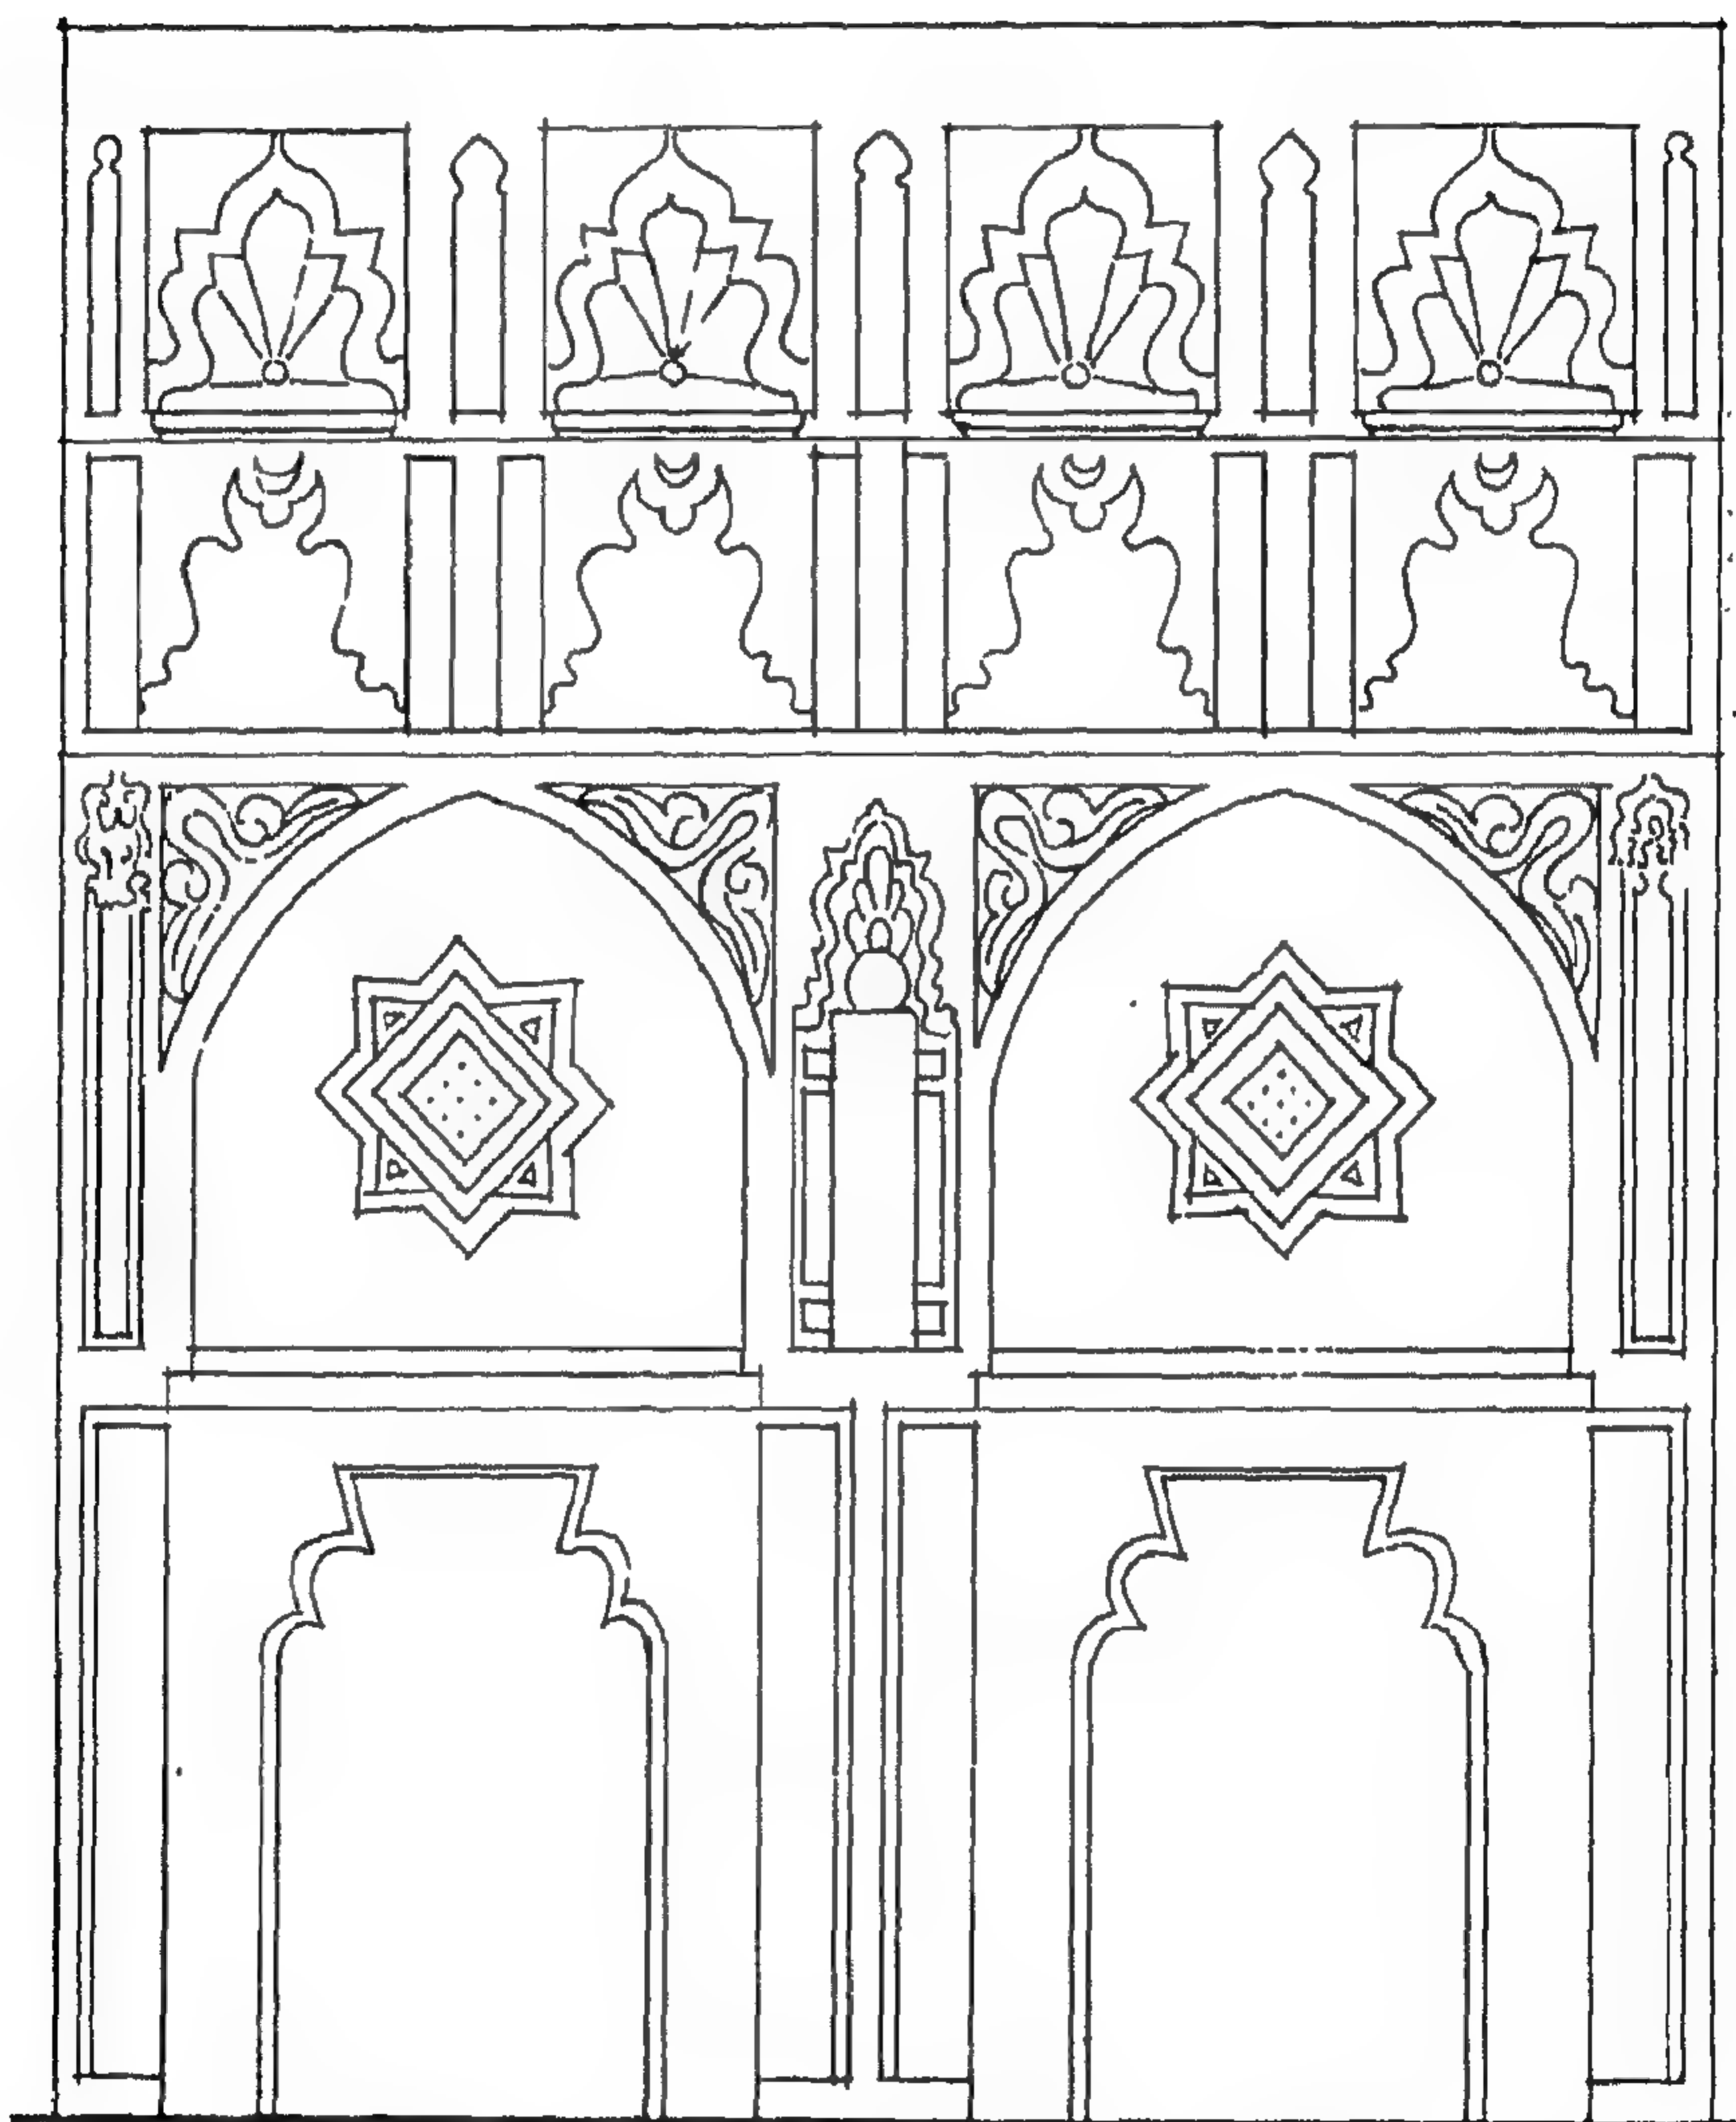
رسم تخطيطي لمدرسة أبي منصور
